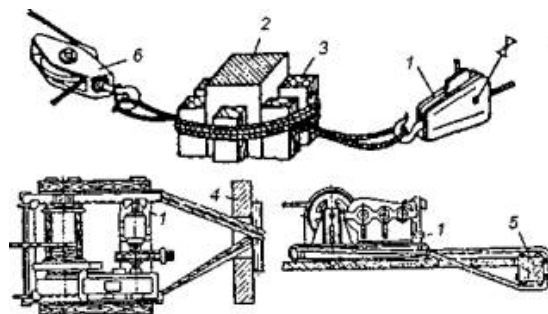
Закрепление лебедок за колонну, стену и ригель:
